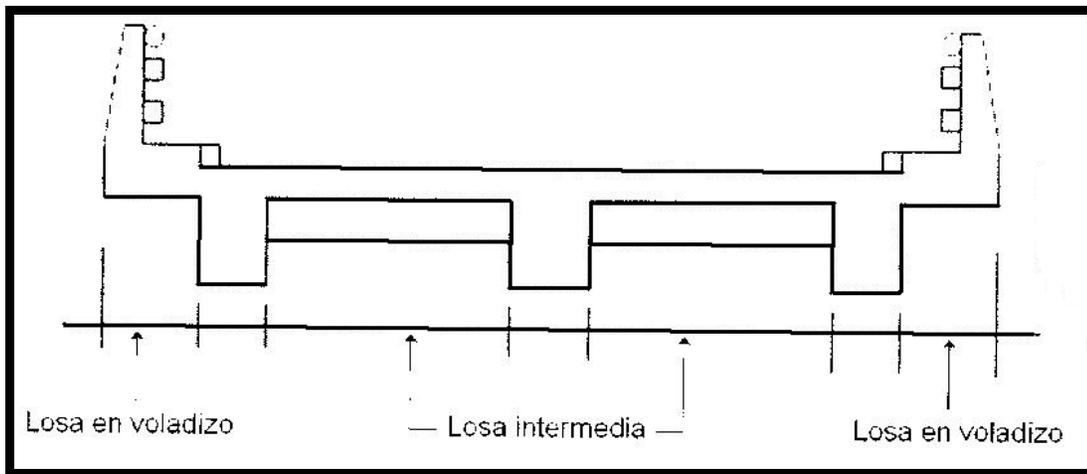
Tipos de losas en la sección transversal de un puente.
